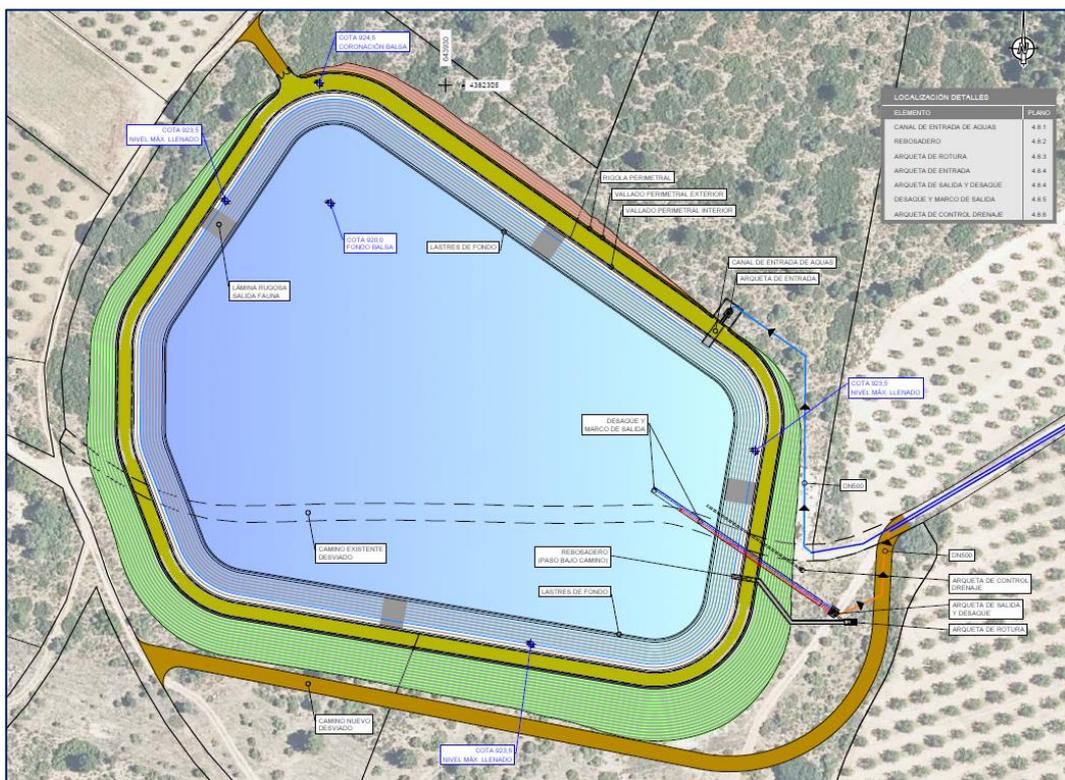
Planta ubicación Balsa A de 80.000 m³ de capacidad.
